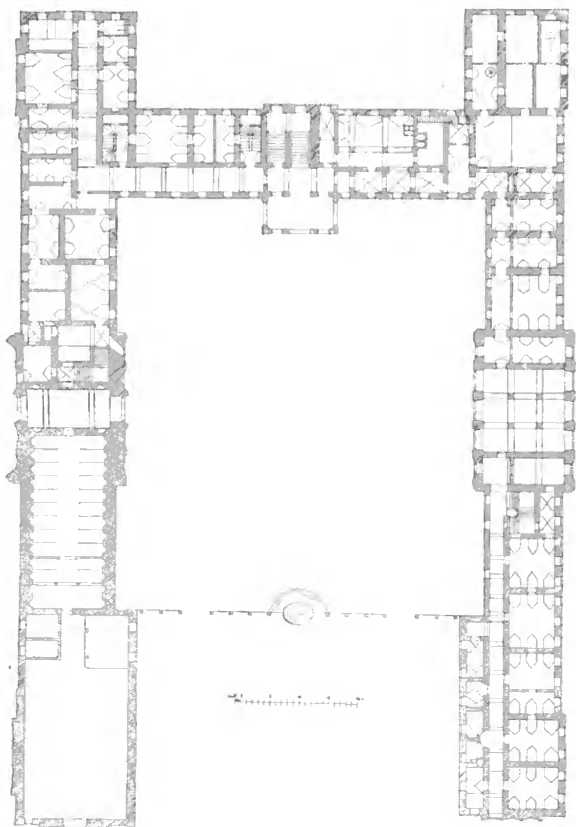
Dobříš. Grundriss des Schlosses.
